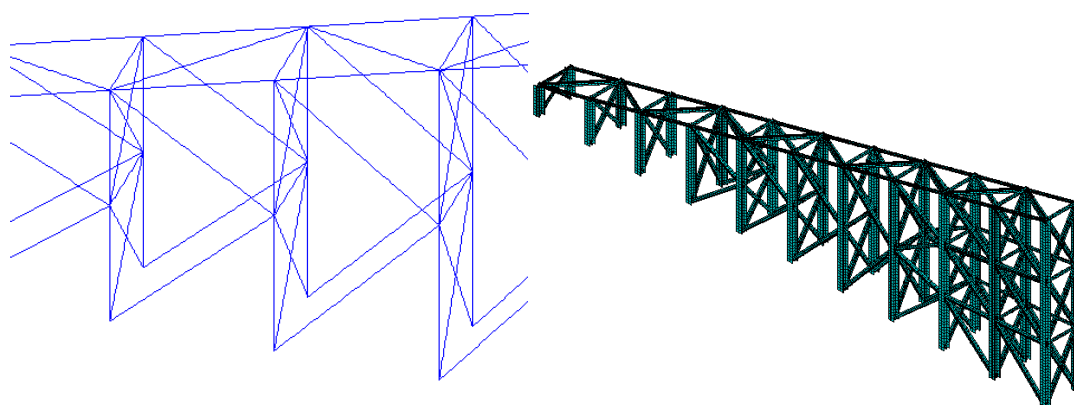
Caso 3: vigas adicionais e elementos 3-D
